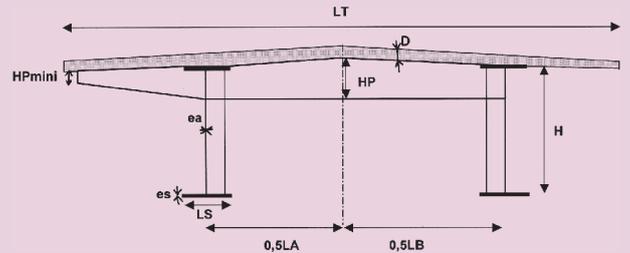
Paramètres du dimensionnement d'un bipoutre à pièces de pont (à gauche, avec consoles ; à droite, sans console)
